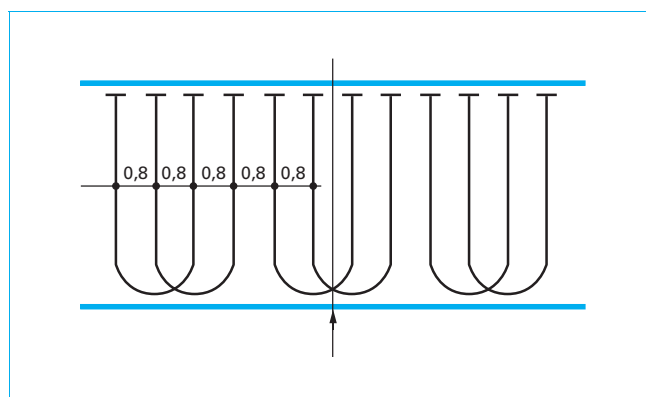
Exemple de précontrainte verticale dans les âmes d'un caisson au droit des appuis intermédiaires
